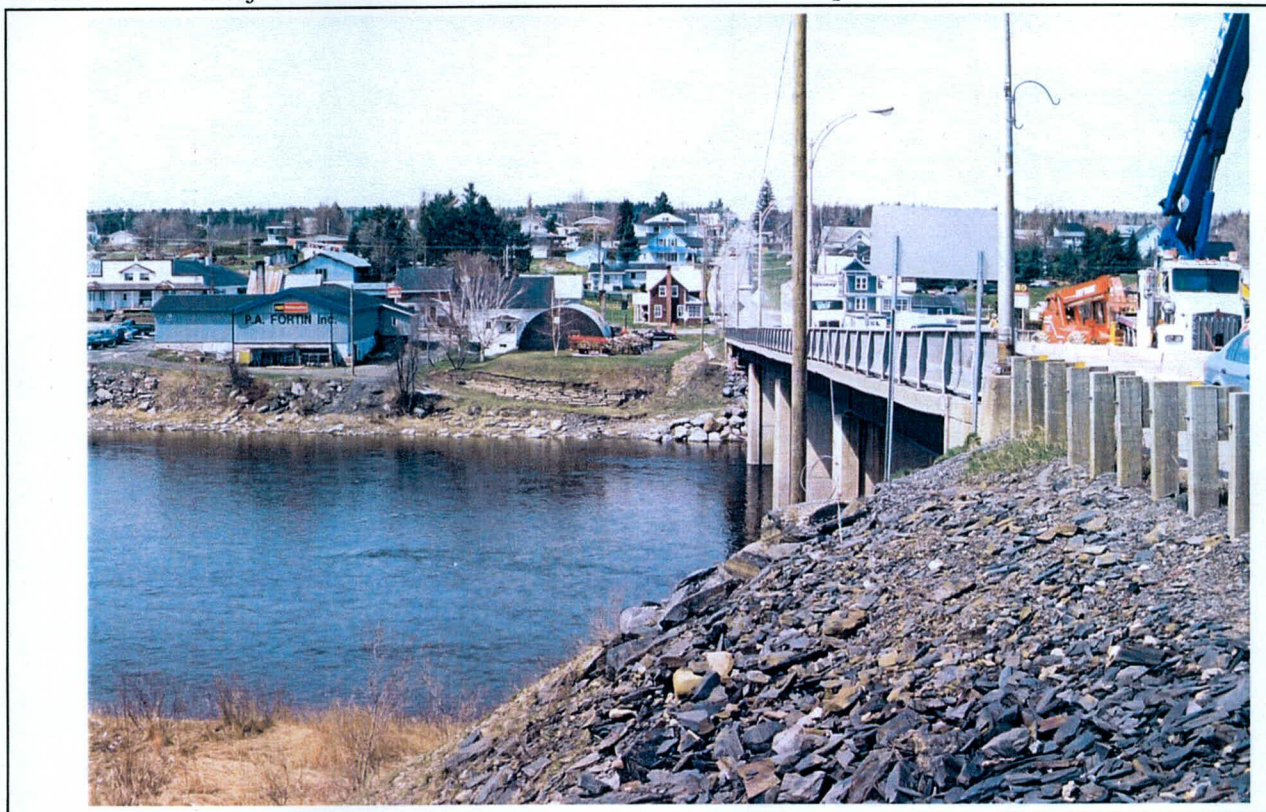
Projet 20-3471-9721, route 269, intersection des routes 269 et 204 (SE)
